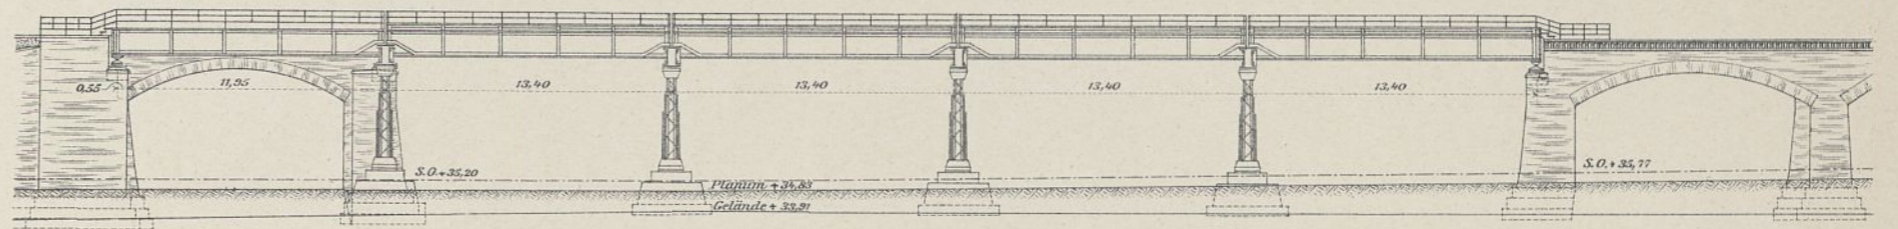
Ansicht nach e-f des Grundrisses. 1 : 350.
